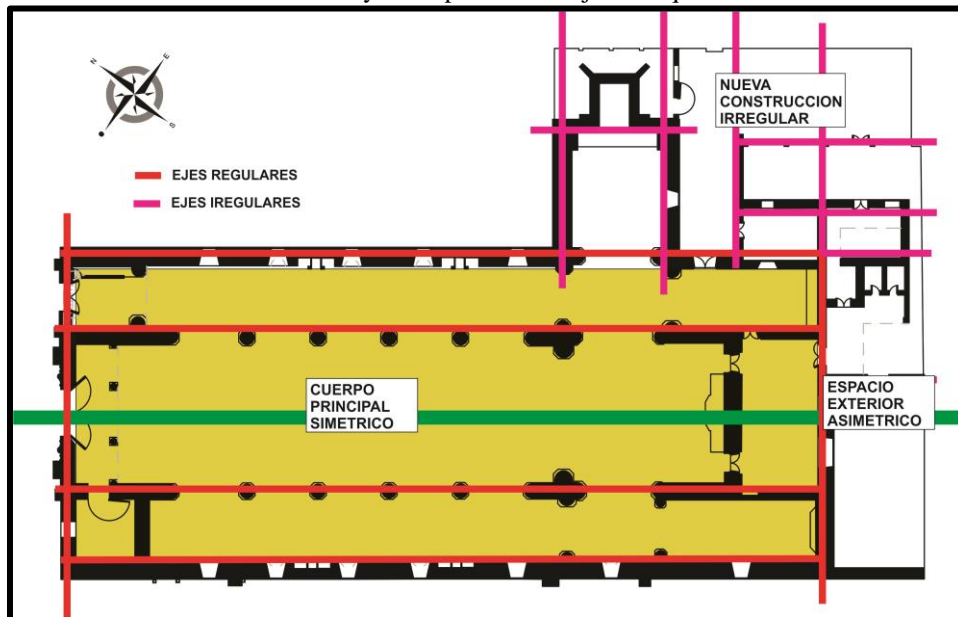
Ejes conceptuales sobre la planimetría básica del conjunto arquitectónico
